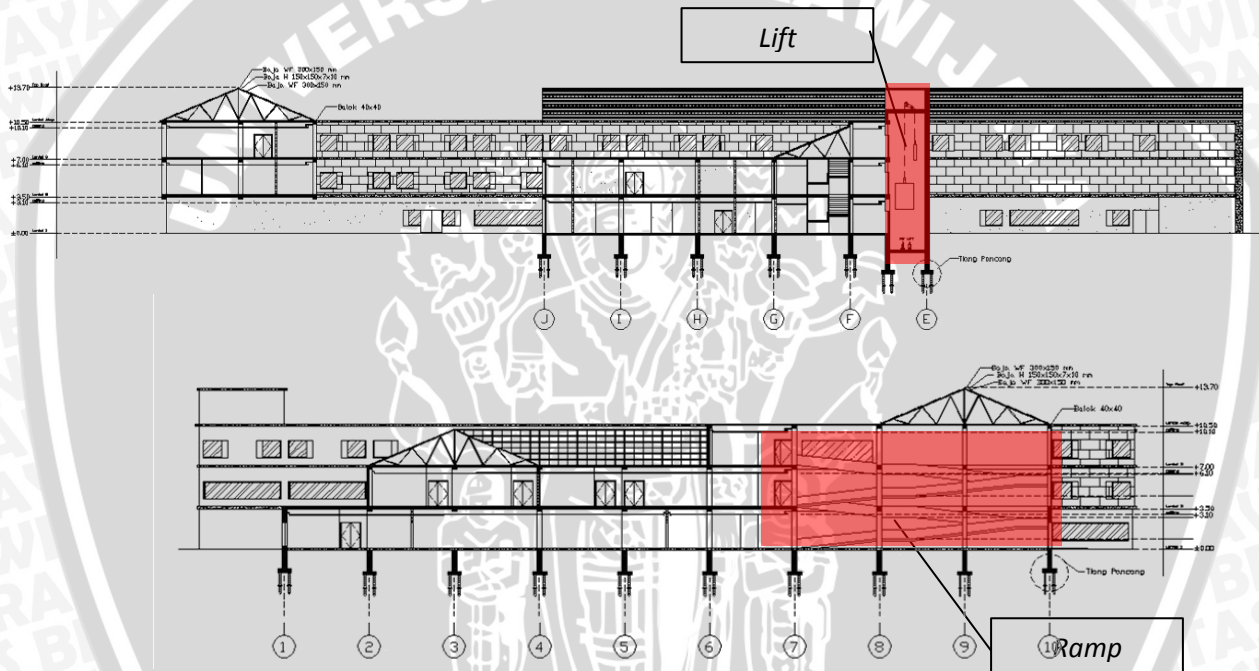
Pondasi tiang pancang pada potongan bangunan
